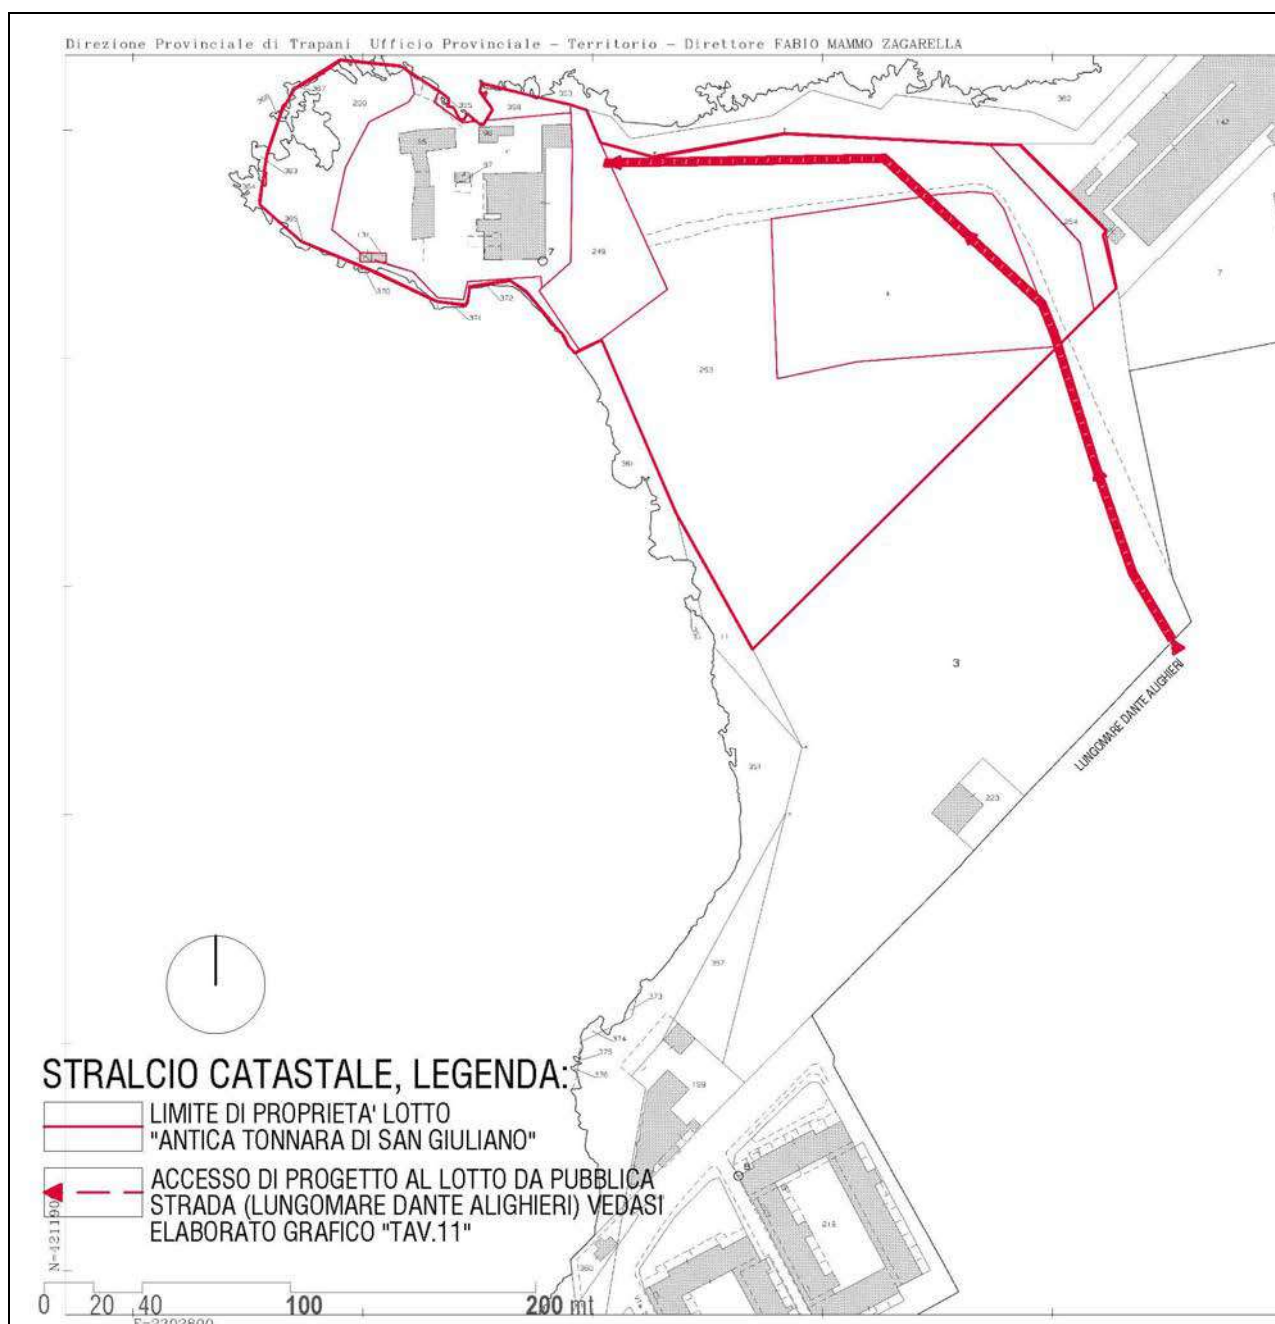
Planimetria dell'accessibilità alla Tonnara in fase di esercizio
